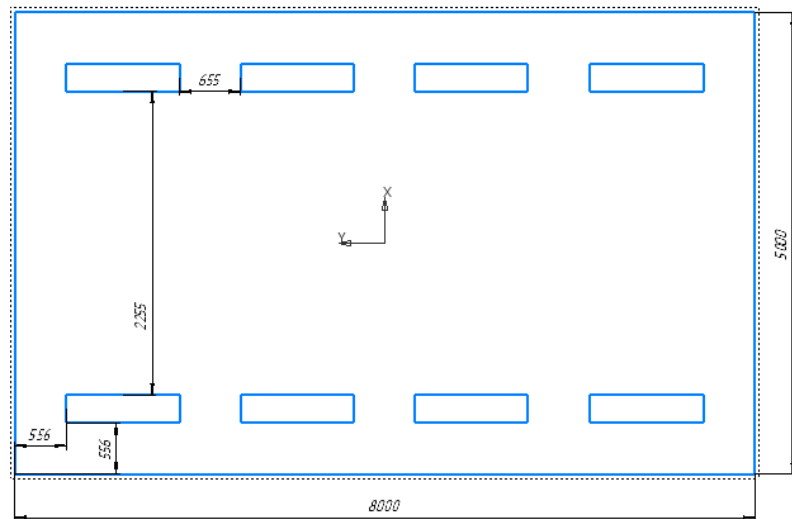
План помещения и размещения светильников с люминесцентными лампами
